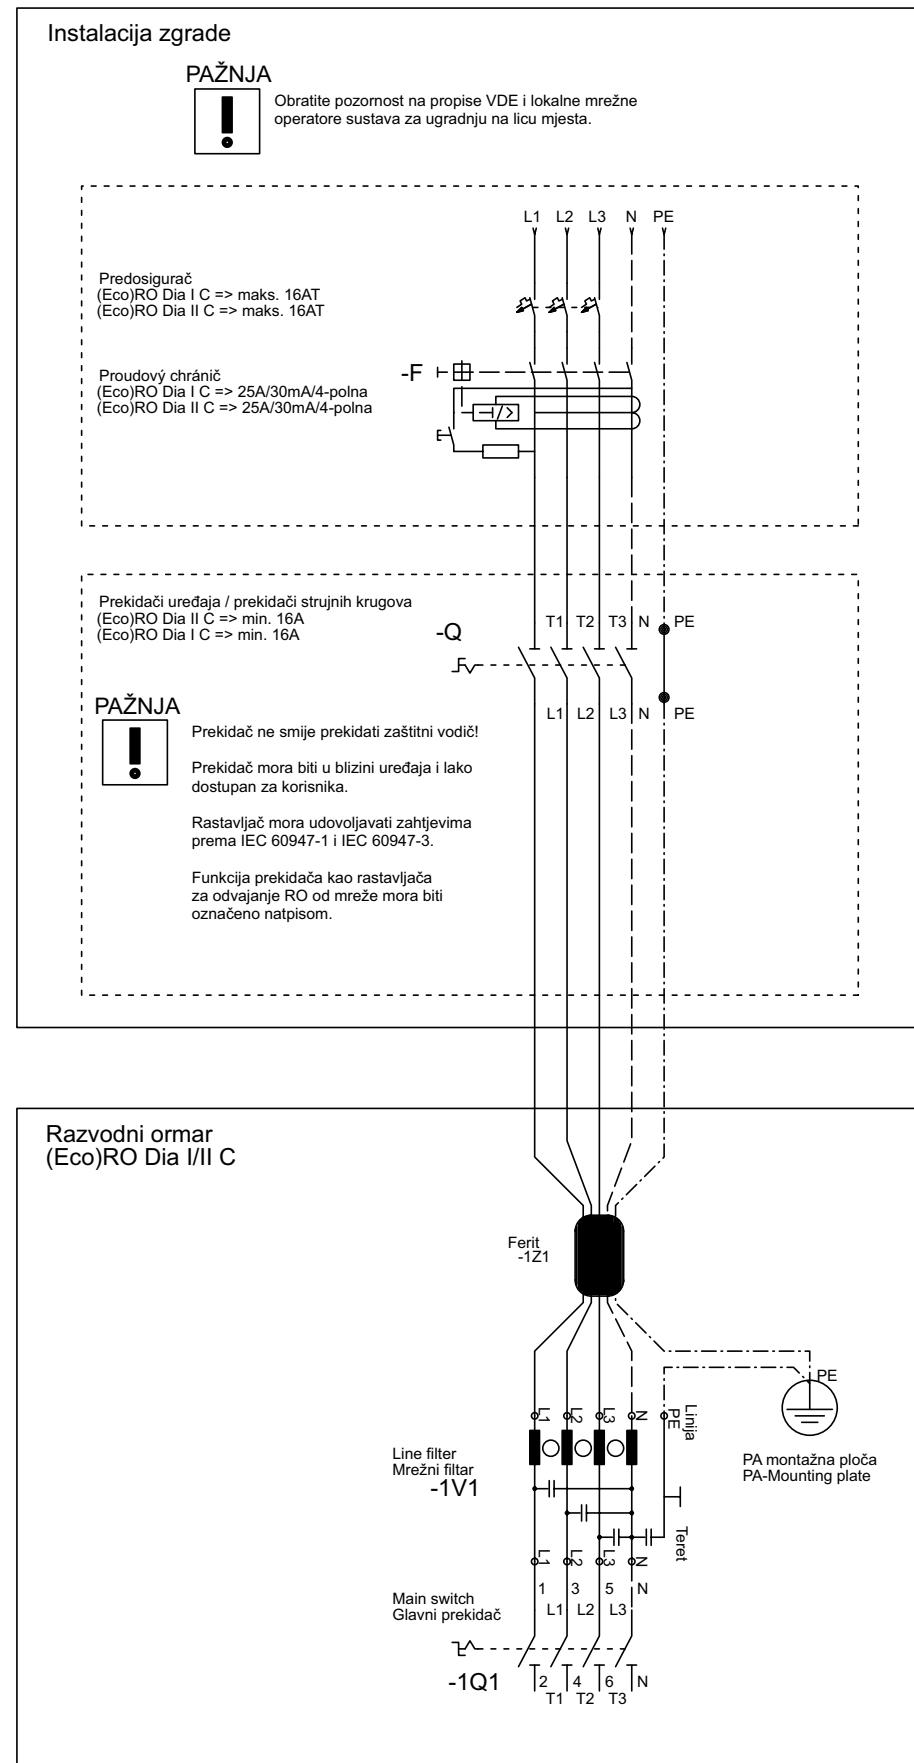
Plan postavljanja (Eco)RO Dia II C
